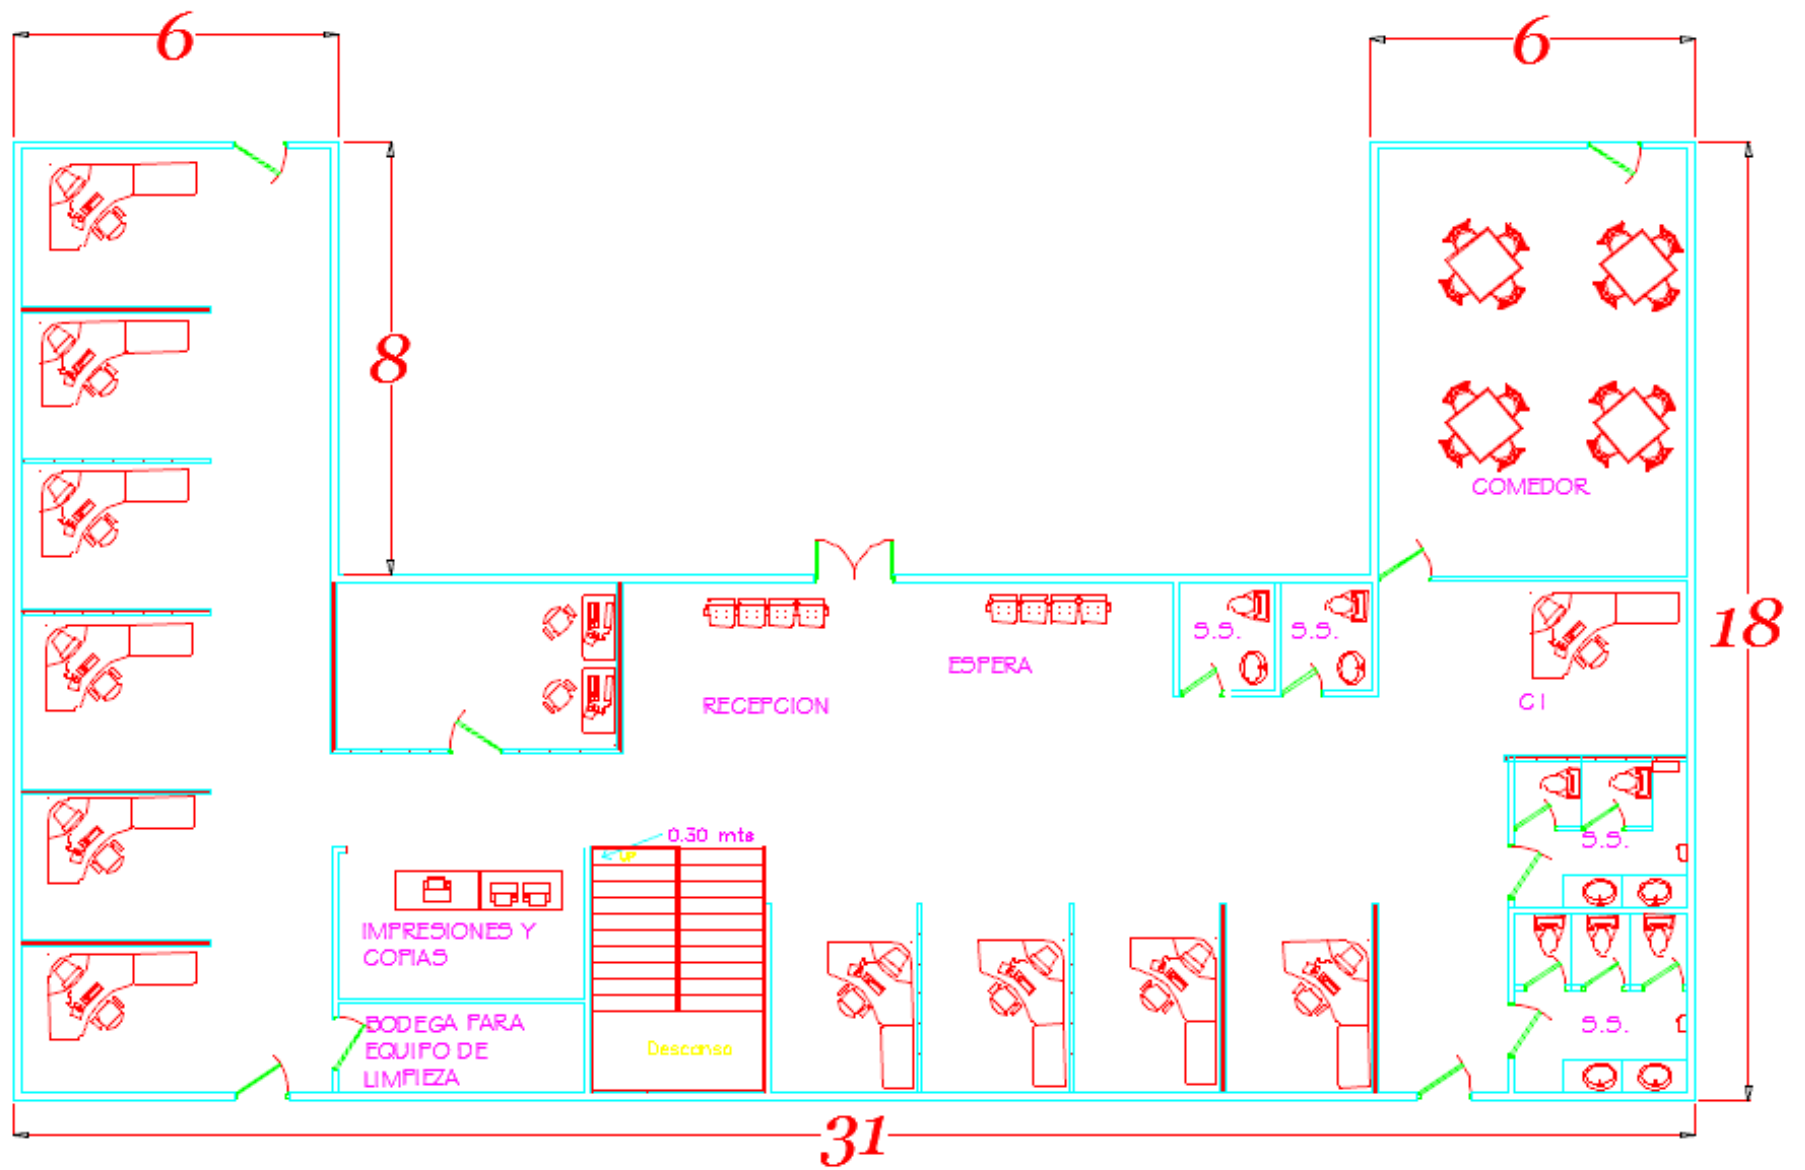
Vista en planta general del primer nivel, acotada y sin escala.
